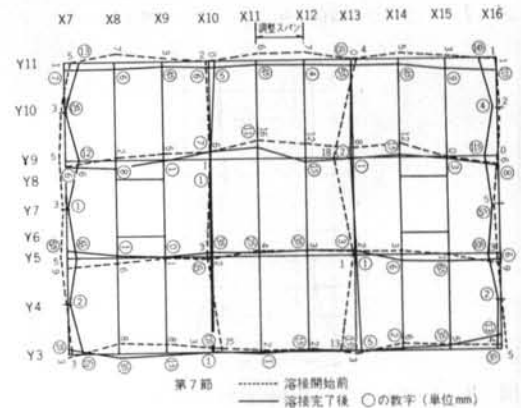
B建物の溶接前・後の柱の位置の例(平面図)
